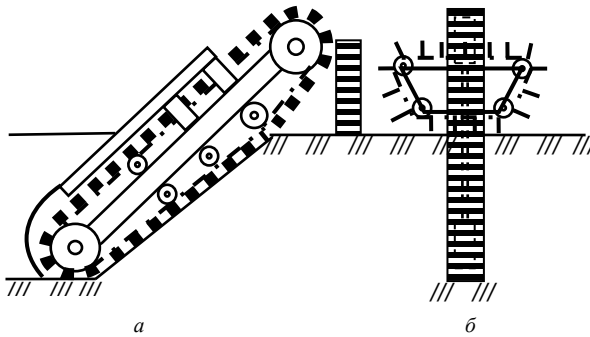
Схема скребкового цепного траншеекопателя с поперечным скребковым цепным устройством для отодвигания вынутаго грунта:
